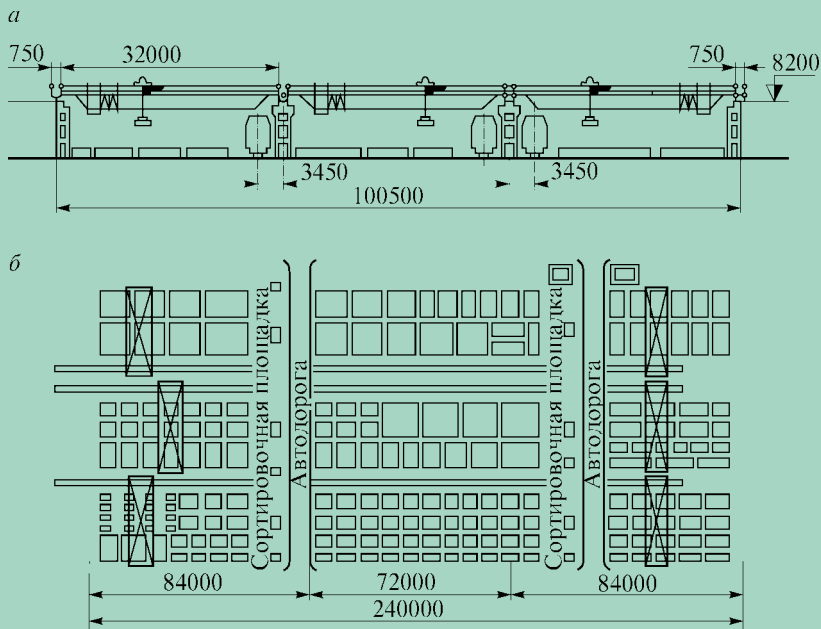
Открытая площадка, оборудованная мостовыми кранами:
